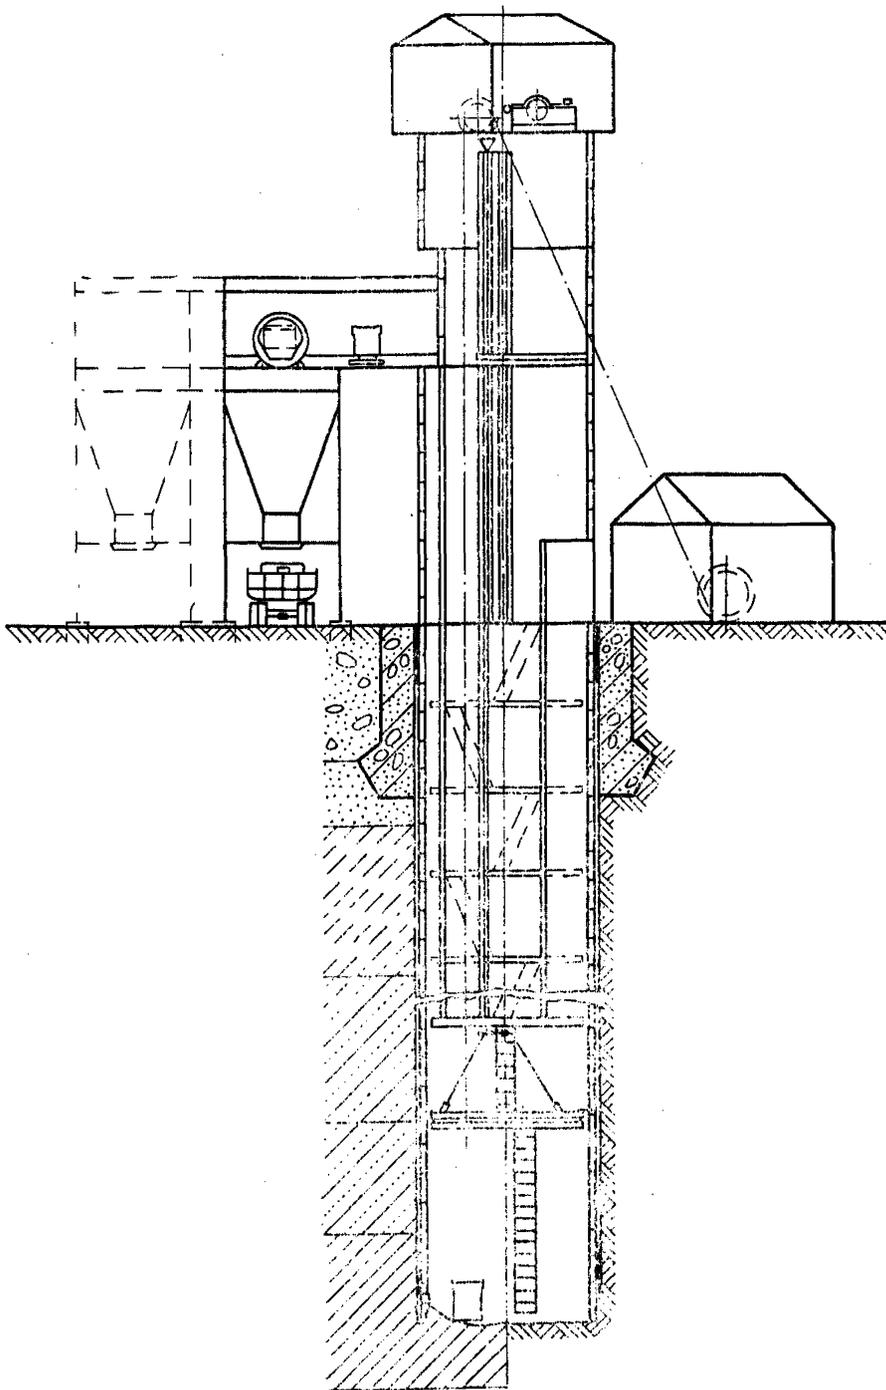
Переход от попружения крепи к проходке в устойчивых породах (откачка воды из ствола; закрепление тиксотрольного раствора цементными поясами; установка армировки ствола; чеканка тубинговых колец свинцом; монтаж котра, подъемной машины, бункеров; демонтаж ножевого кольца и установка тубингового кольца подводкой тубингов снизу)
